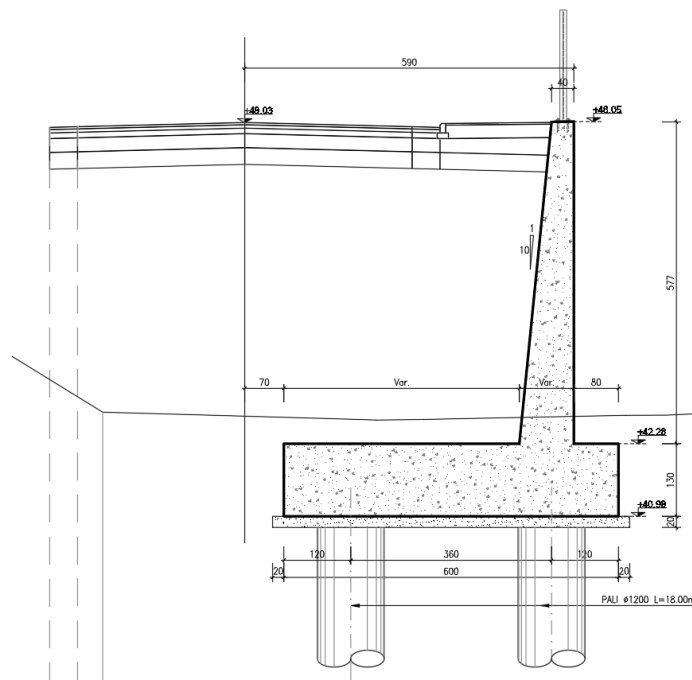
Sezione trasversale muro lato spalla B in dx
